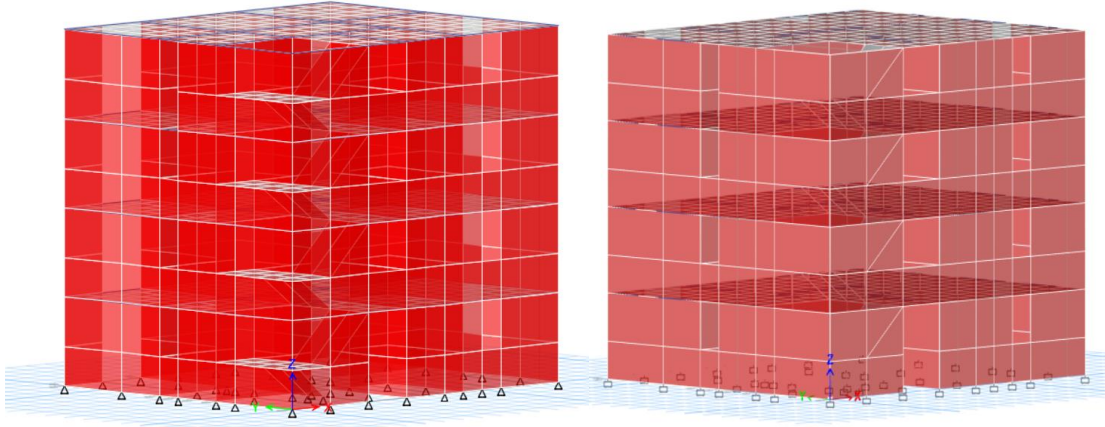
Modelo 1 con discretización mínima de los muros de mampostería y apoyos articulado (1A) y empotrado (1B) respectivamente.
